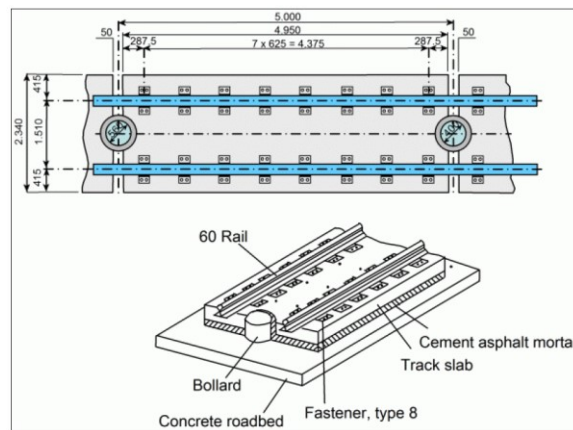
Esquema del sistema de losa flotante sin traviesas japonés Shinkansen
